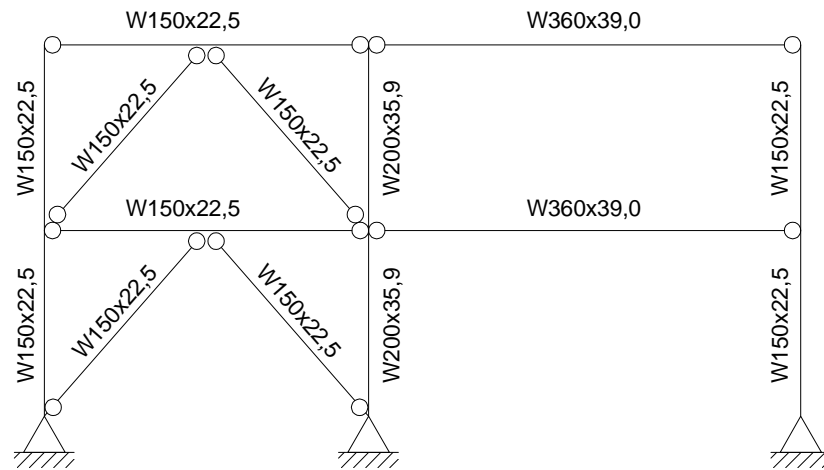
Modelo estrutural e seções adotadas para as barras do pórtico plano de dois pavimentos.
